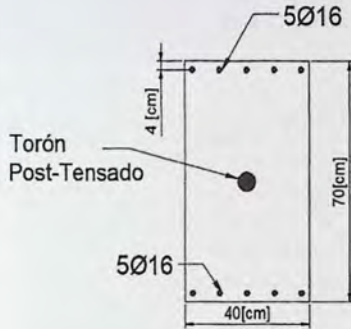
Distribución de refuerzo longitudinal en vigas.
